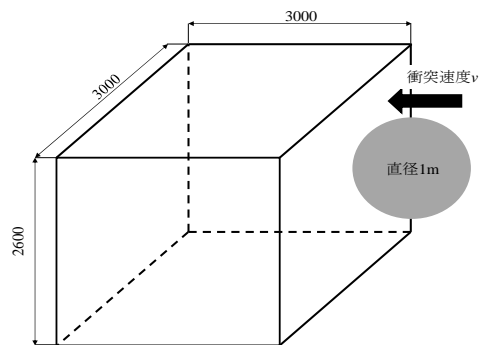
コンクリート砂防堰堤袖部モデルへの礫衝突
